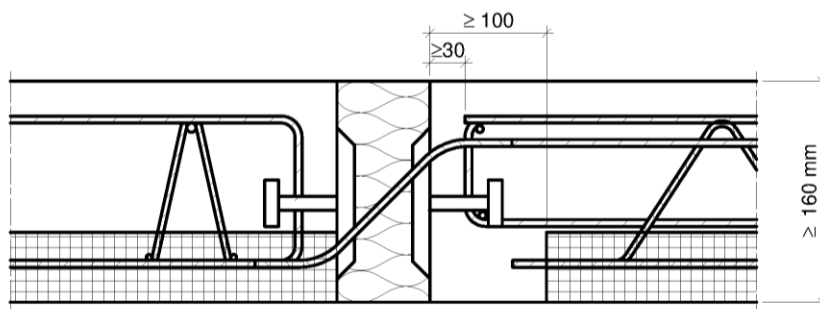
Beispiel Schöck Isokorb® Typ Q mit Elementplatten
